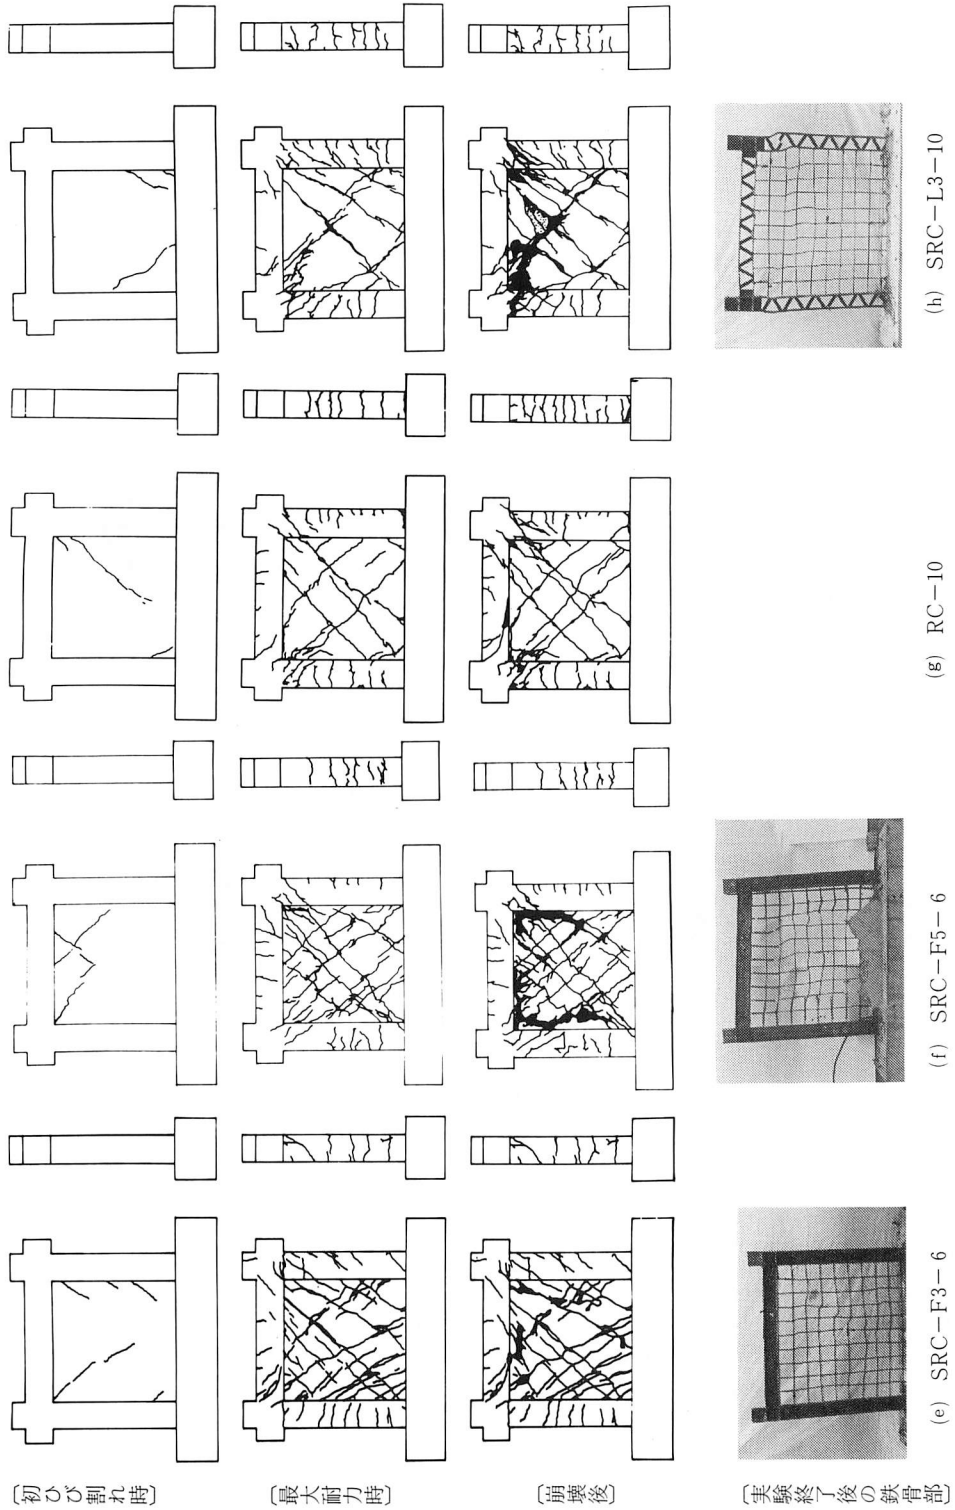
ひび割れ状況, 及び実験終了後の鉄骨部 (その2)
